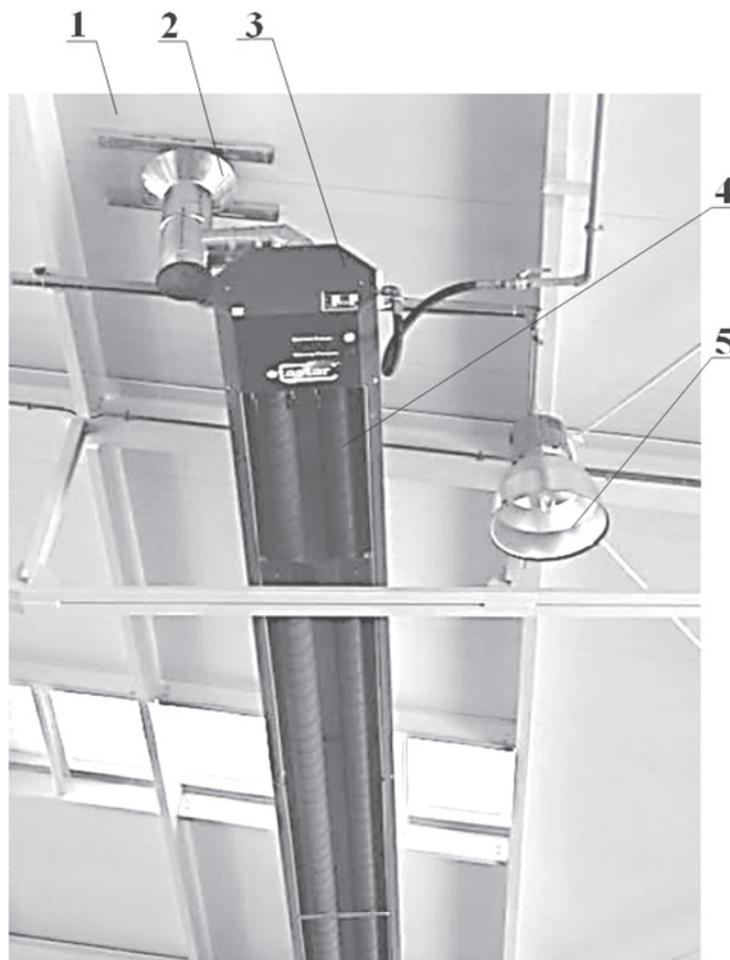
Общий вид ленточного инфракрасного обогревателя ETASTAR TURBO:
